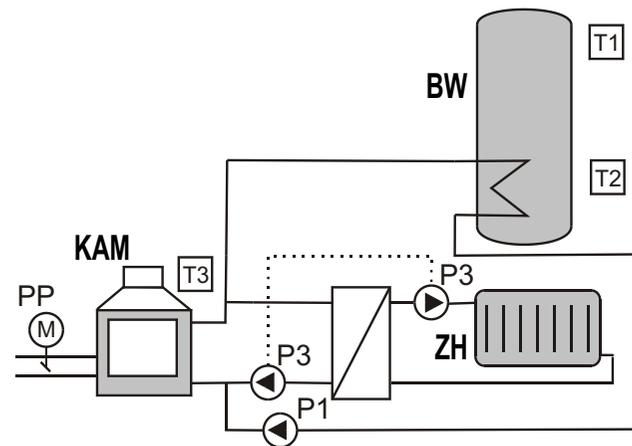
Betriebsschema des Reglers mit Wärmeaustauscher für ZH Schaltung
